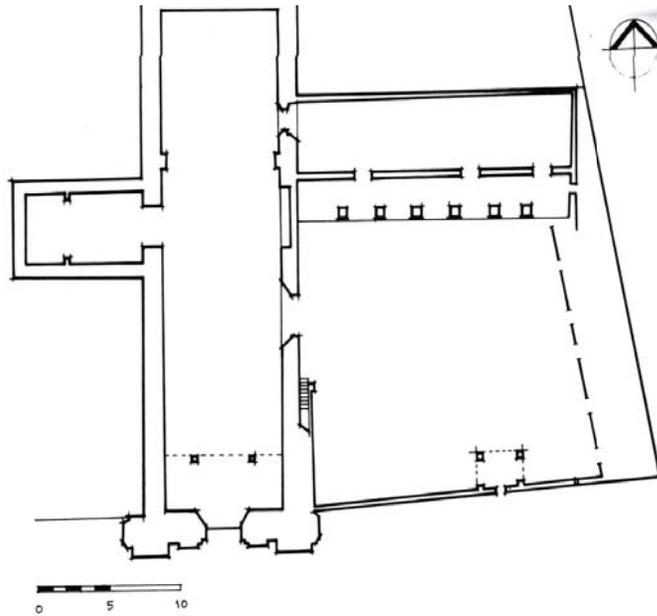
PLANTA GENERAL DEL TEMPLO MEXICANOS. Fuente: Artigas, J.B.
